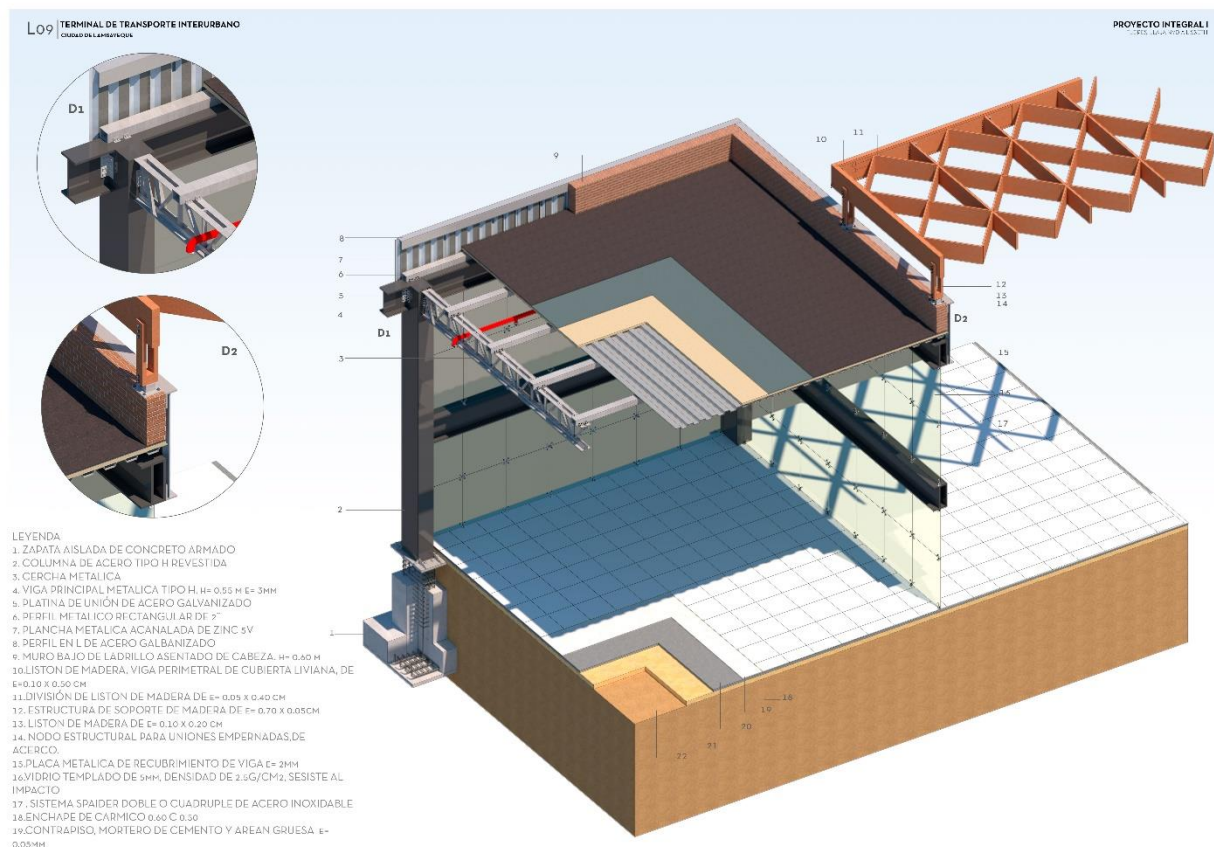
Sección constructiva. Fuente: Elaboración propia
